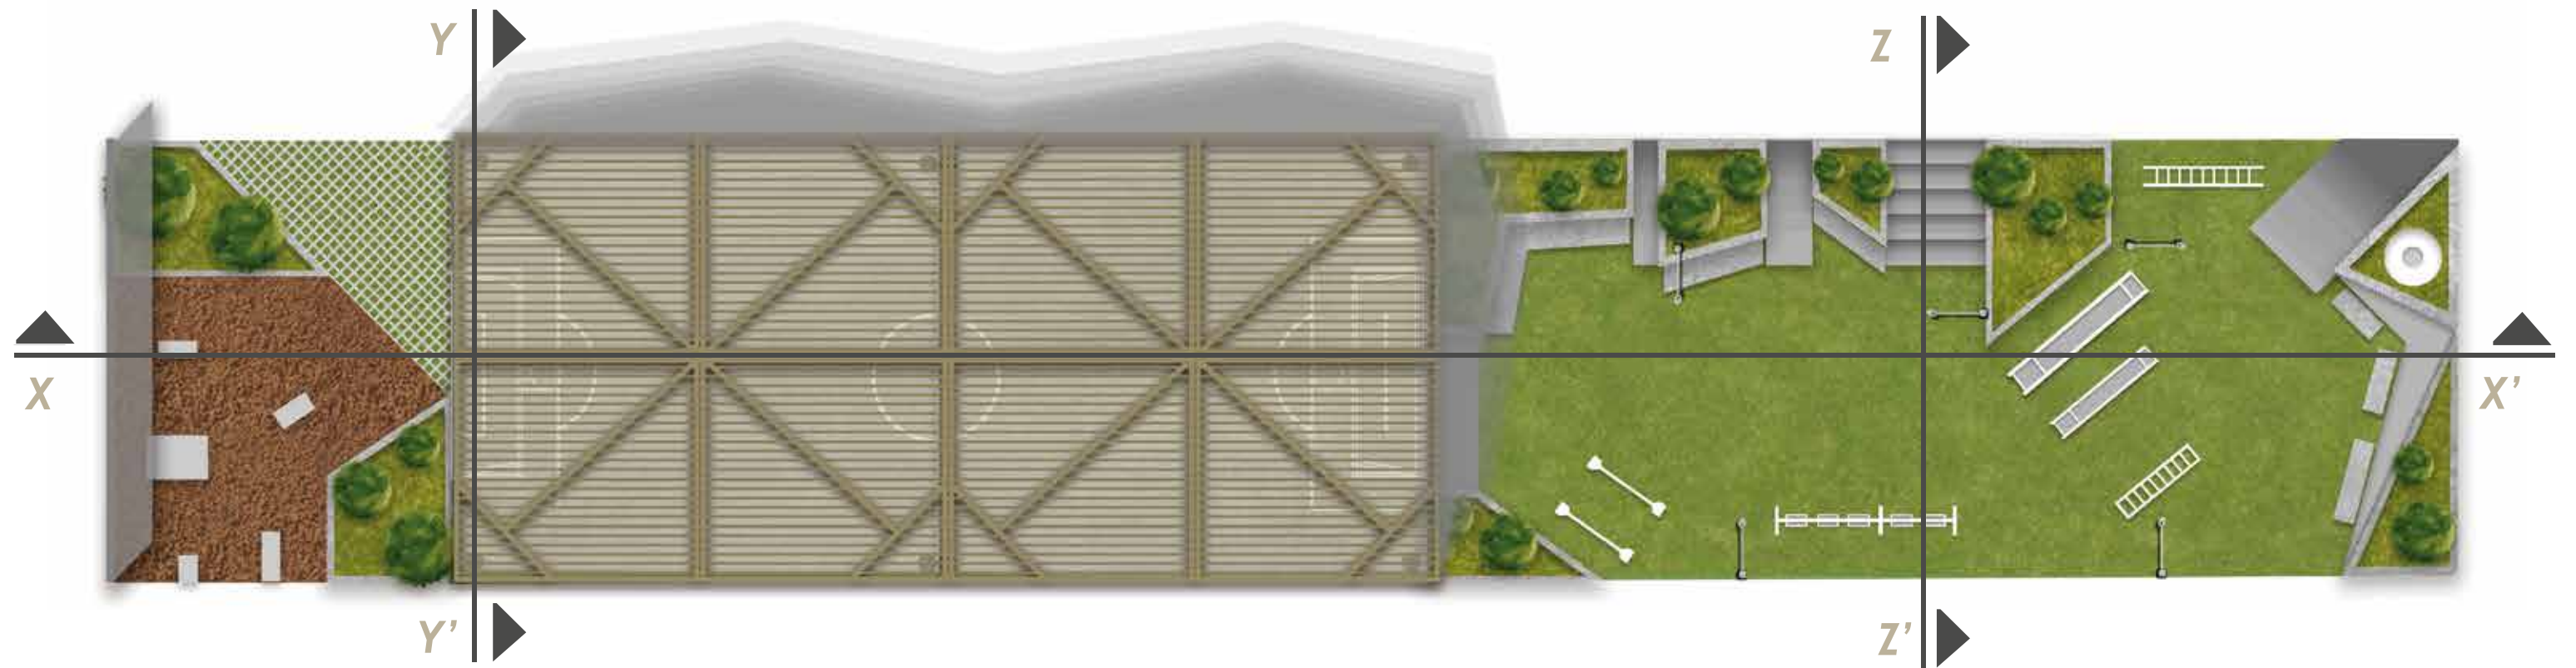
Plano de conjunto de la Propuesta Final
